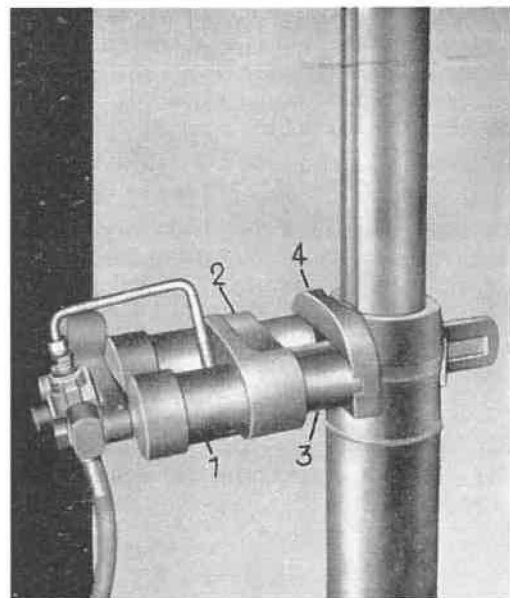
Dispositif hydraulique de calage des serrures d'étançon.
